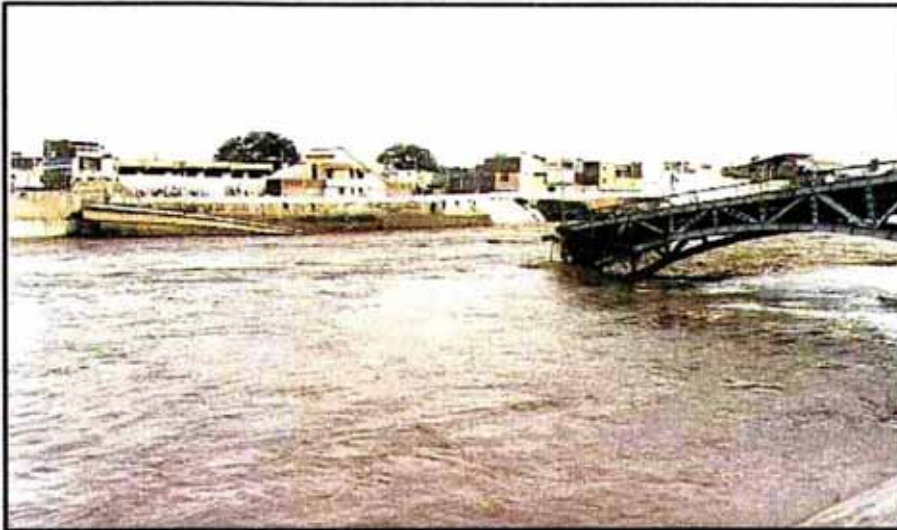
Puente peatonal sobre el río Piura en reemplazo del puente colapsado, caudal del río 10 m³/s. (20.11.98).
